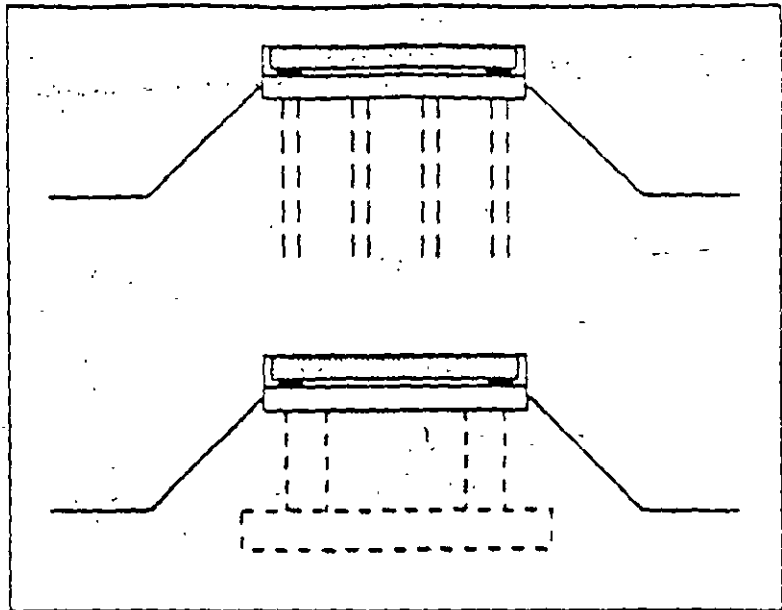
Estribo, tipo 21, enterrado, columnas o pilotes con cabezal
